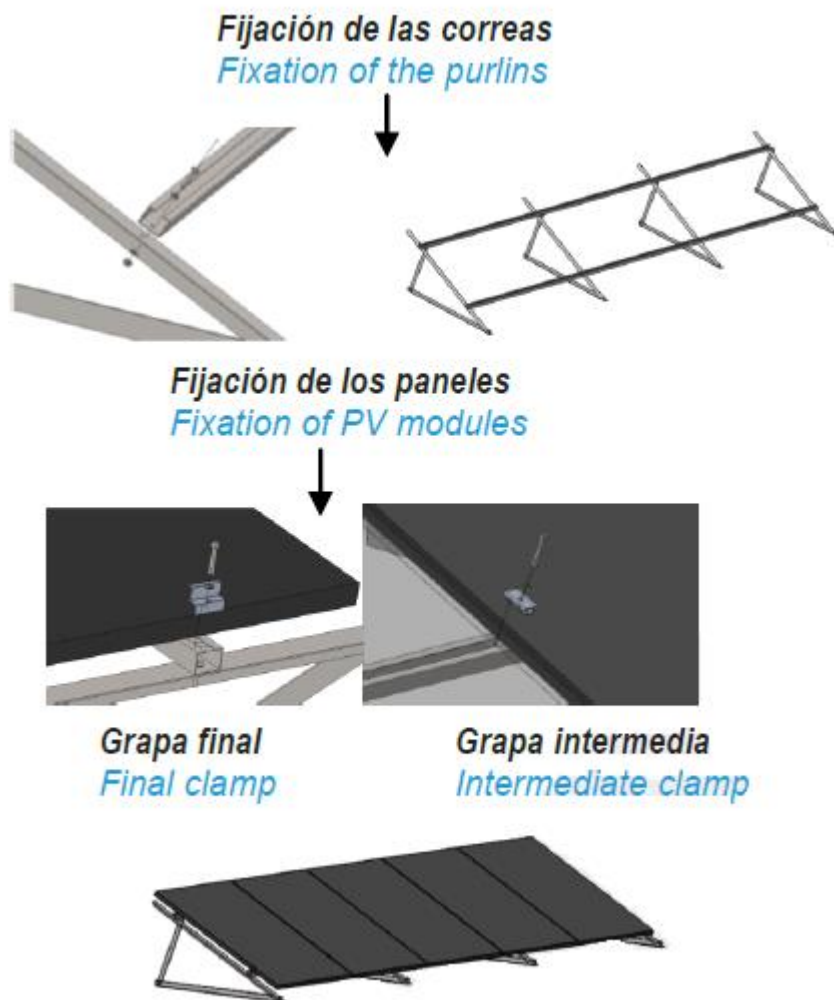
Ejemplo instalación en cubierta con estructura inclinada
